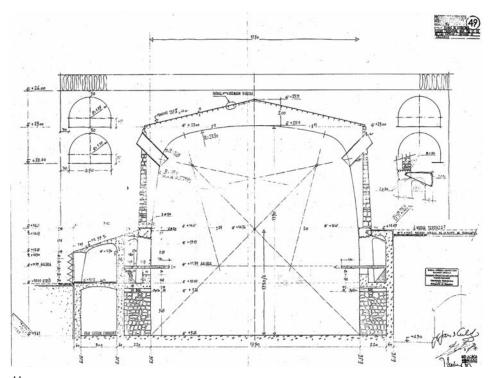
Plano nº 49 del Proyecto de ejecución: Plano de estructura. Sección transversal de la nave. (Archivo del Santuario de Arantzazu)
